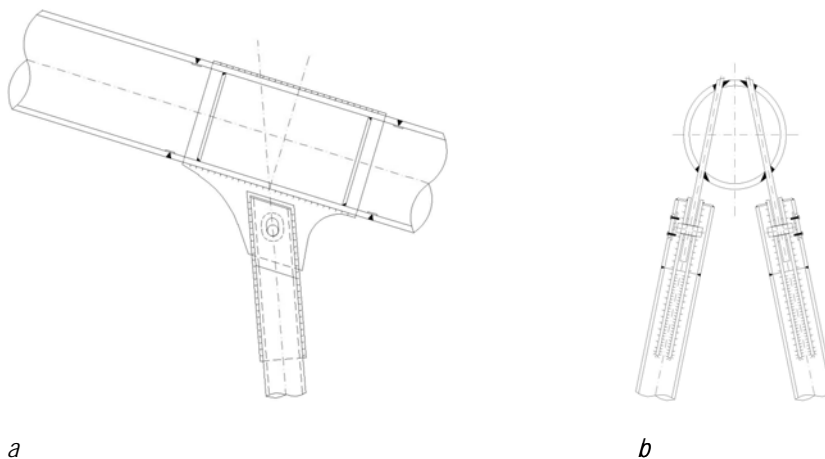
Unión de los tirantes con el cordón superior; a) Alzado; b) Sección transversal
